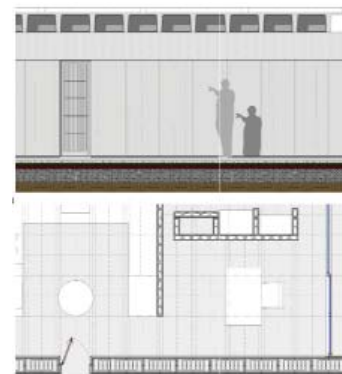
Residência do arquiteto, 1963, East Hampton, New York. Detalhe da planta e da fachada norte.
